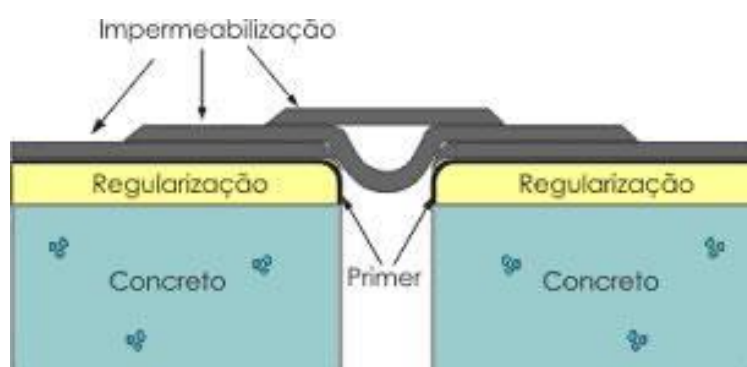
Aplicação da manta impermeabilizante nas juntas de dilatação
